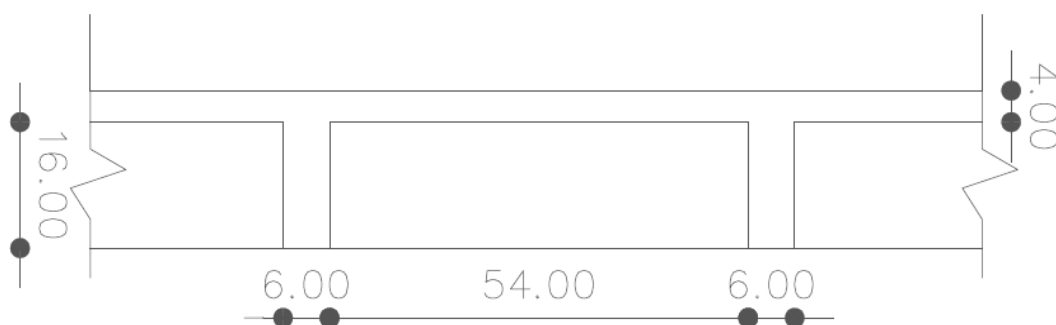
Corte da laje nervurada (do Autor, 2015)
